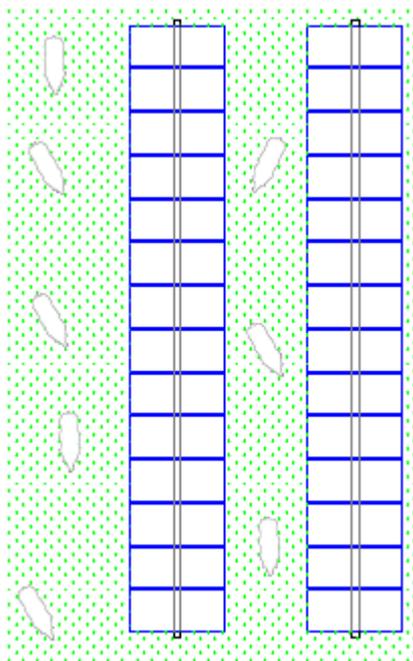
Piantumazione tra le file di tracker (vista dall’alto)
